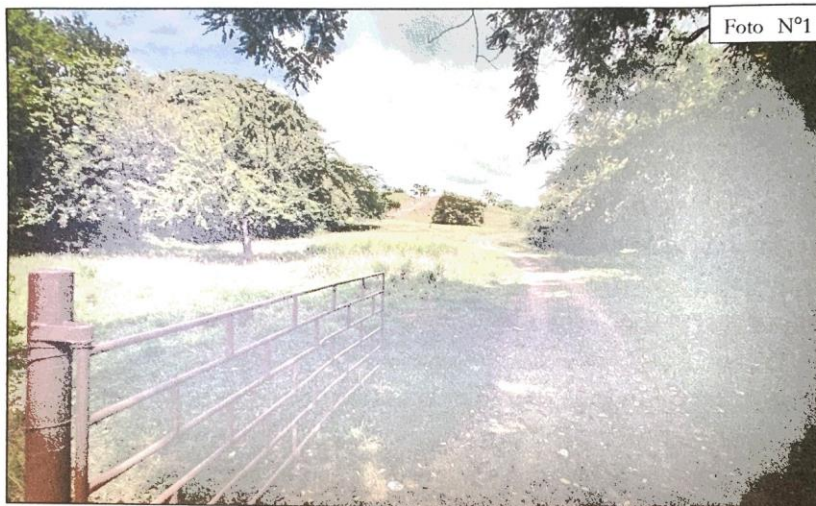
Vista general de la zona de la entrada a la finca a desarrollar.
